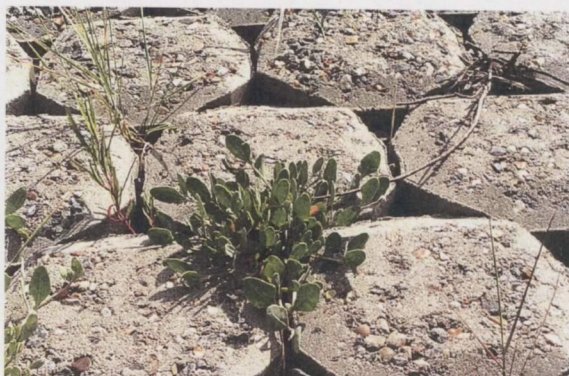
Normale betonzuil (Pitpolygoonzuil) met Gewone zoutmelde en Strandkweek
